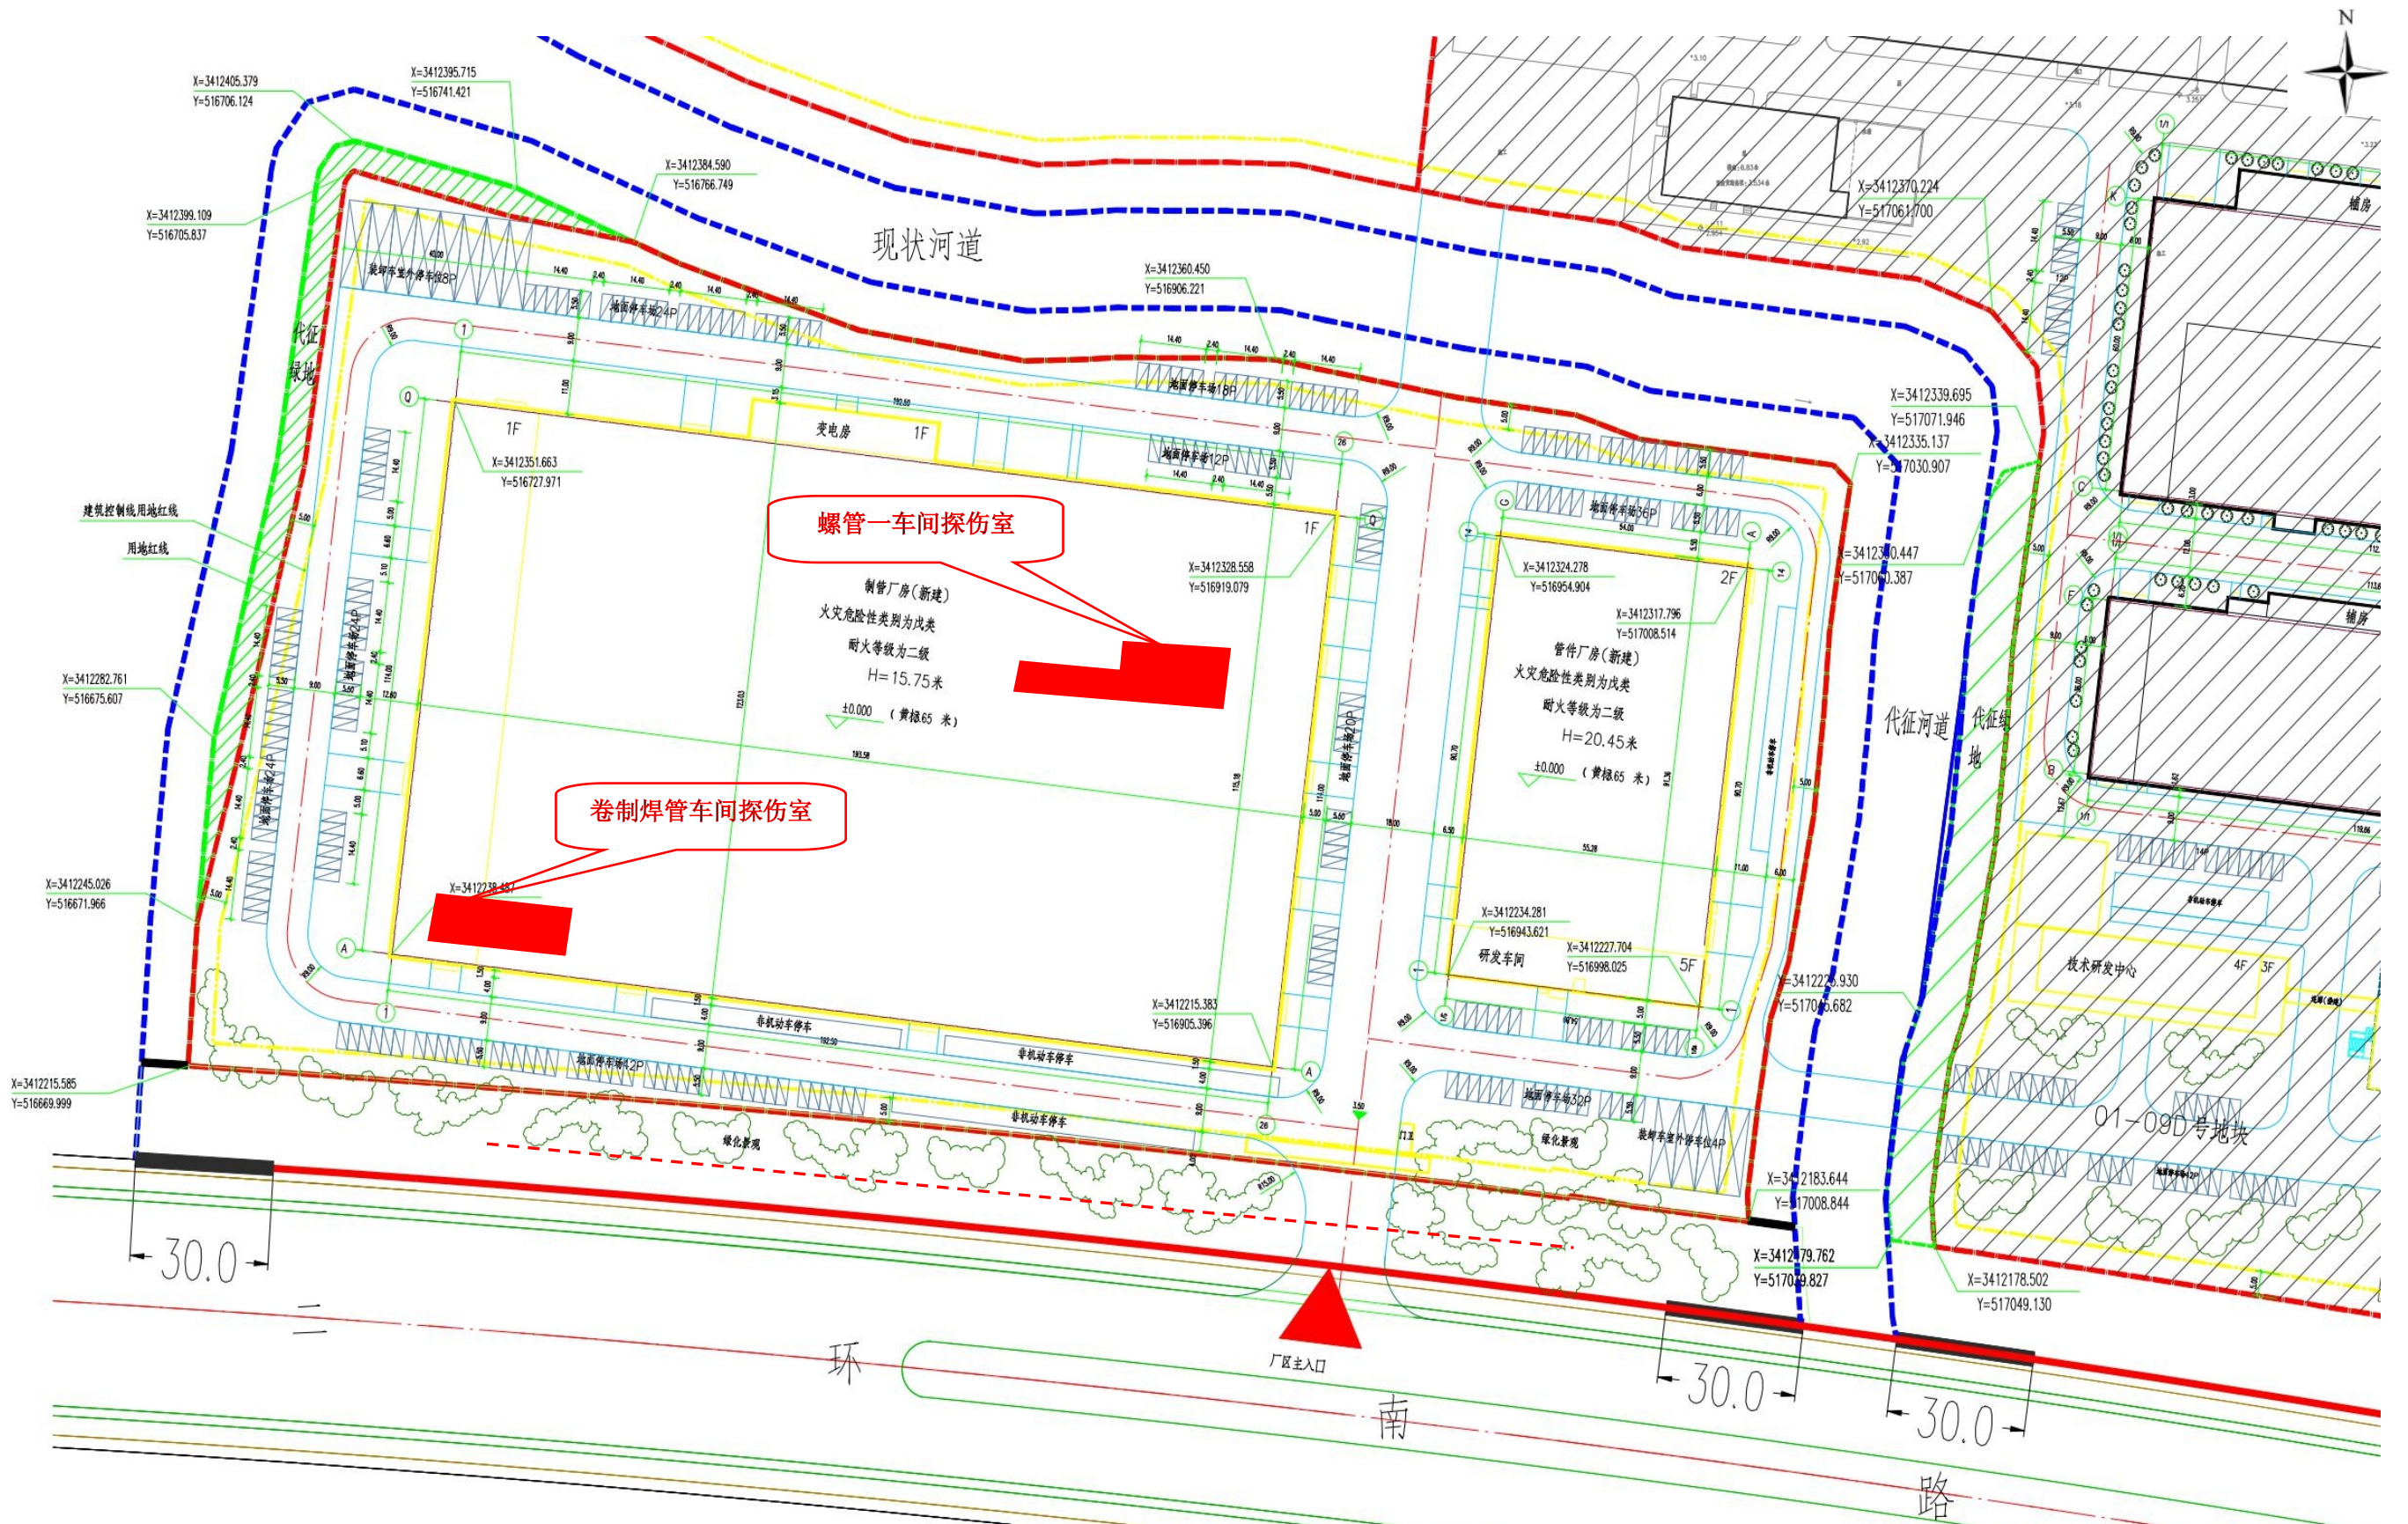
浙江金洲管道工业有限公司本项目厂区总平面布置图
